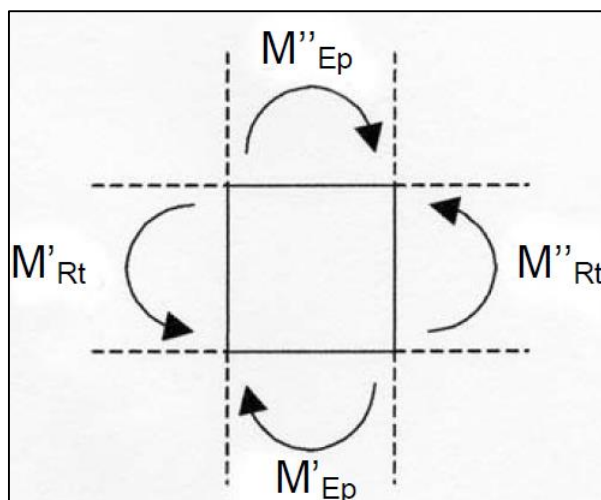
Columna fuerte con viga débil [Toniolo G. (2007)].
